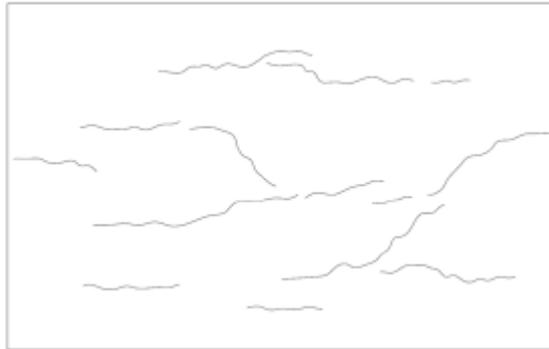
Fissura Típica de Assentamento Plástico.
